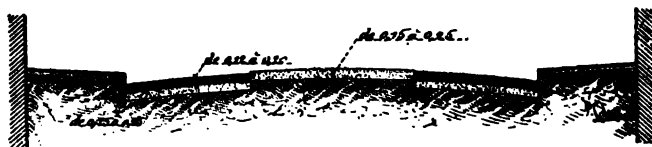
Chaussée mixte. Empièrrement entre deux larges bandes de passage en pierre.
